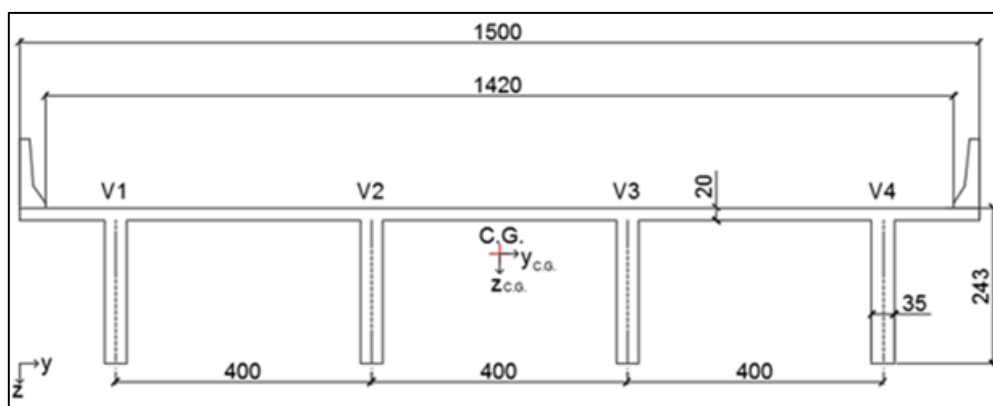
Seção transversal em vigas T moldadas *in loco*.
